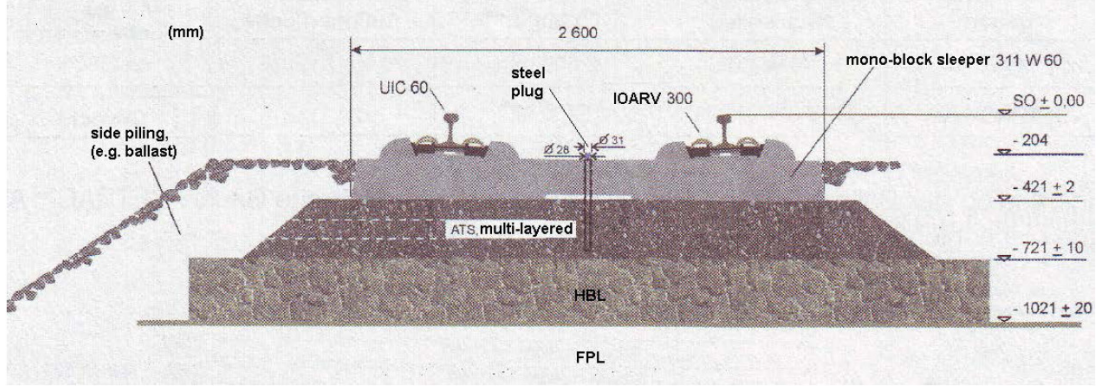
Getrac sistem beton ankraj elemanı [5].
